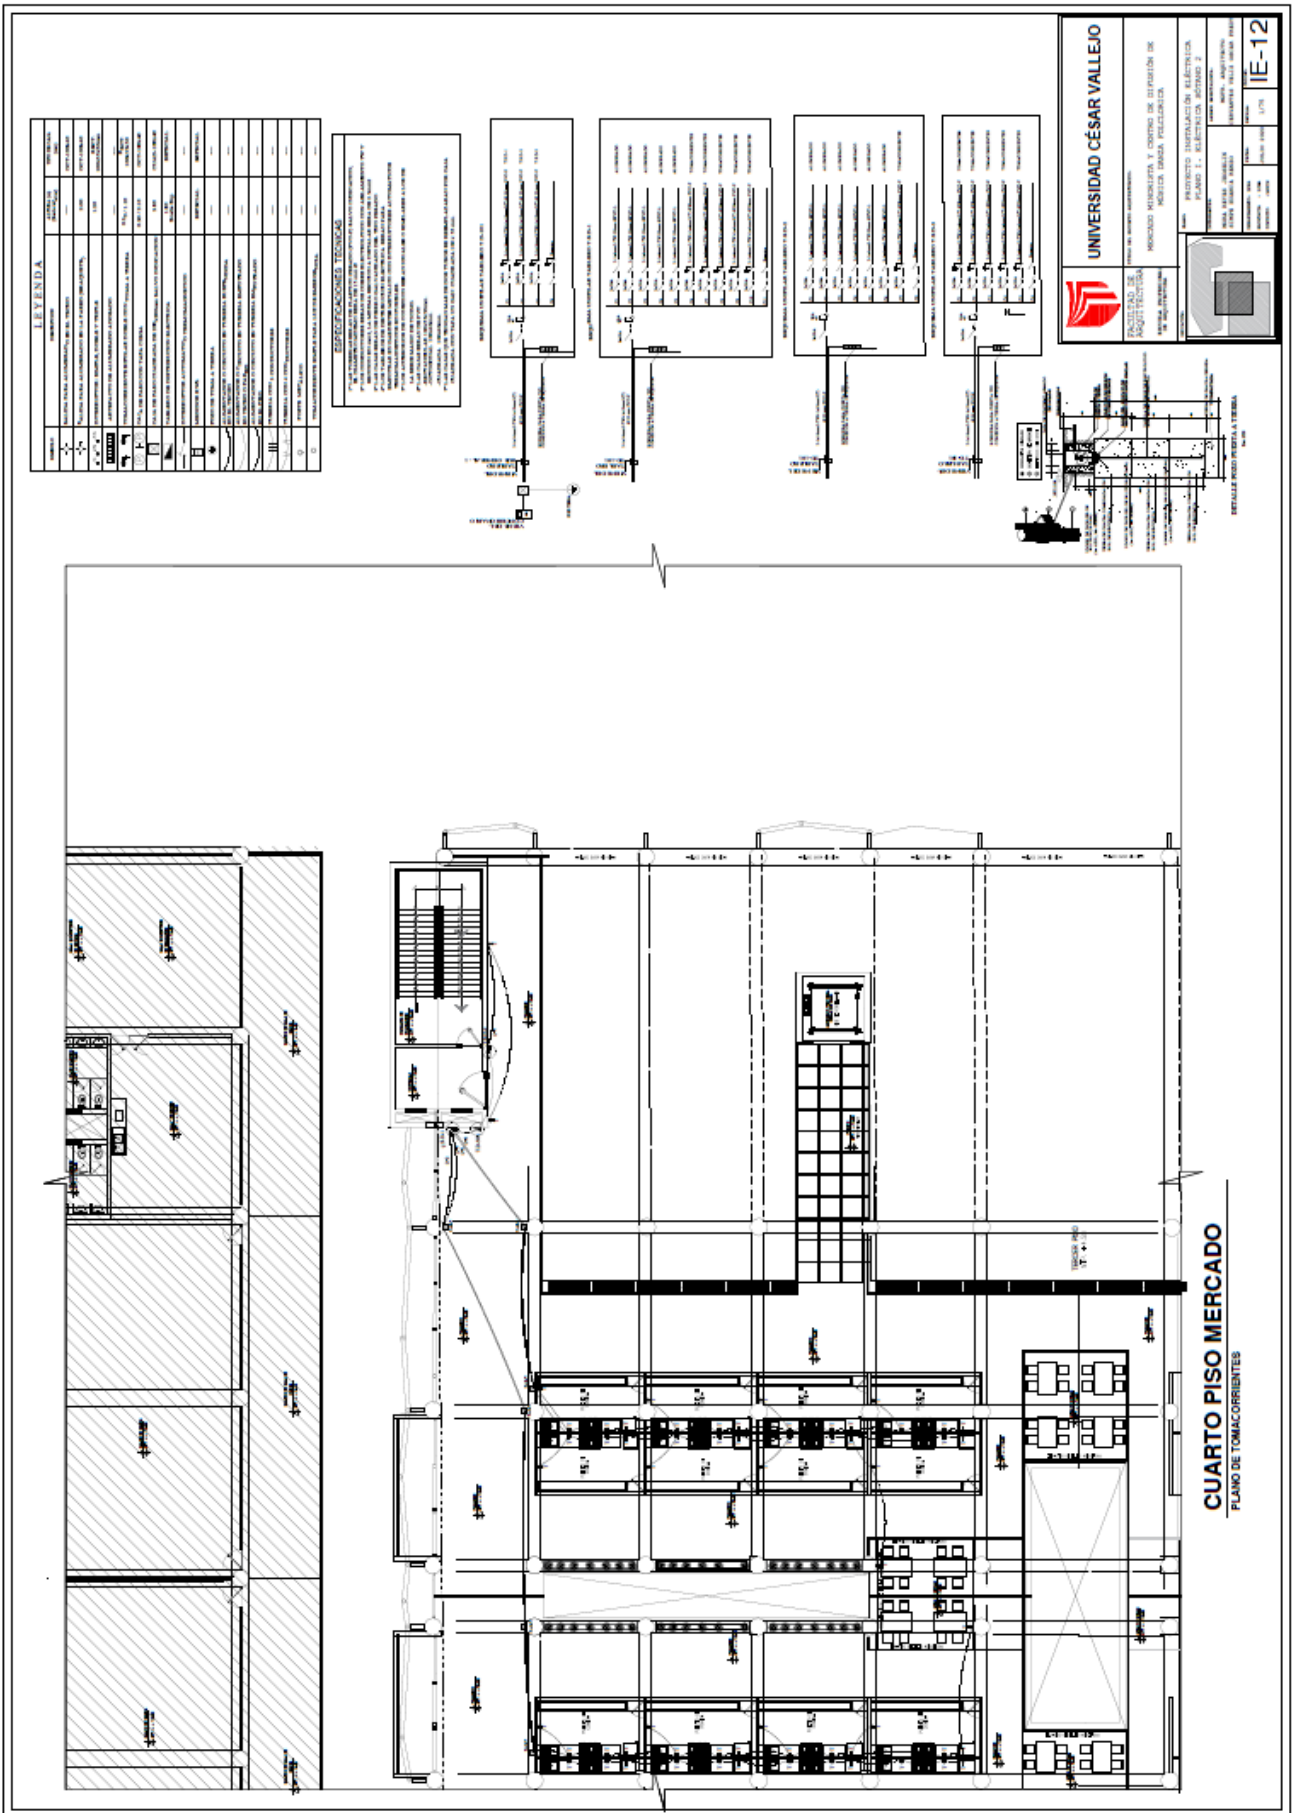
Plano Eléctrico, Cuarto Nivel Mercado - Proyecto
